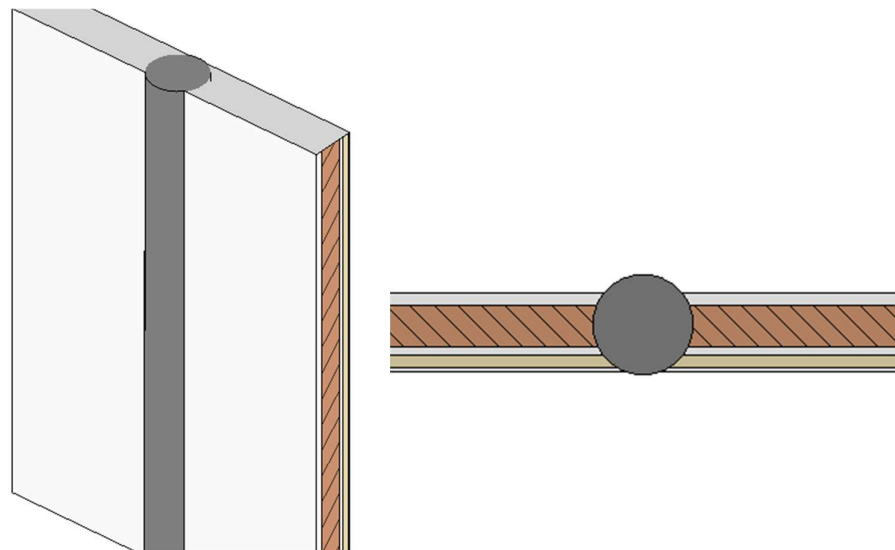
Vista en 3D y en planta del Muro 6.
